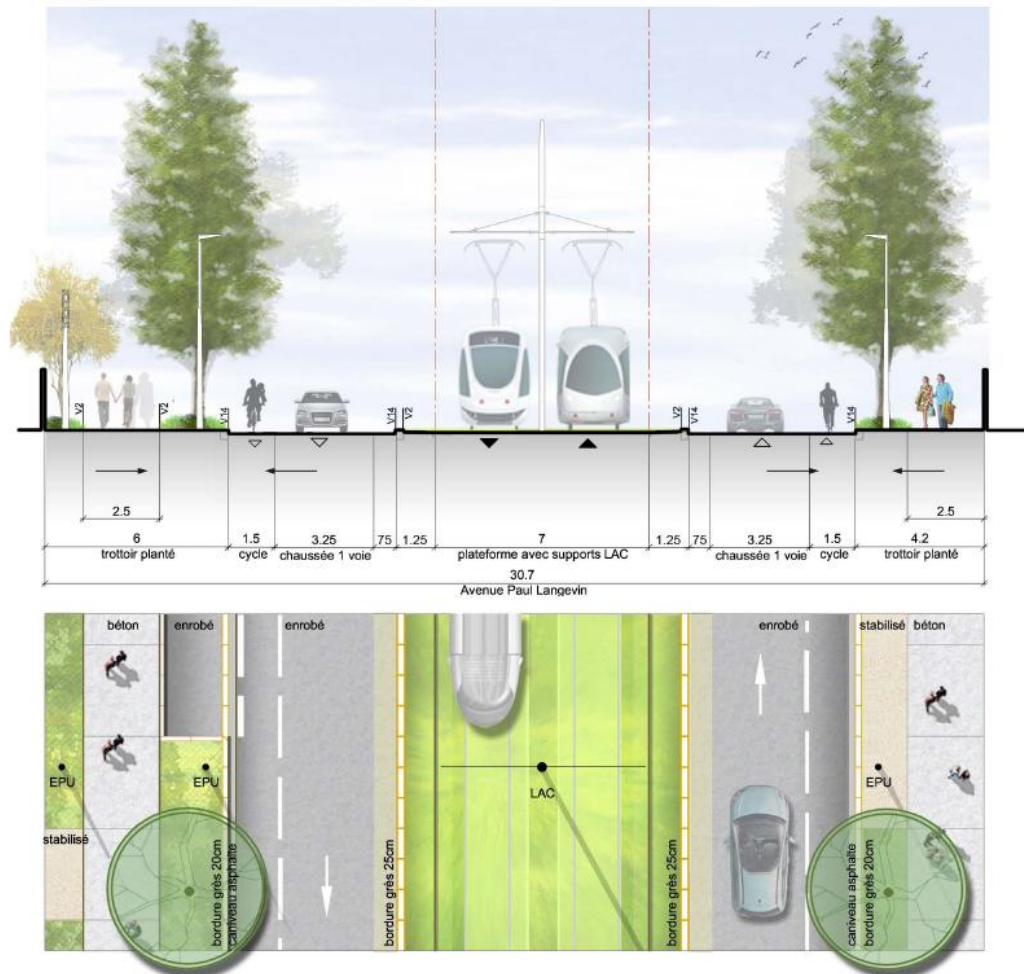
Le plateau parc actif - entrée sur le plateau - coupe S2a et plan d'ambiance
